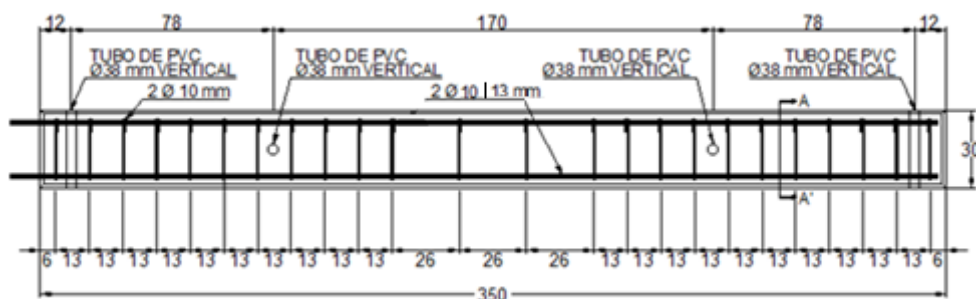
Sección longitudinal de las traves con barras de AR longitudinal a tensión de 10 y 13 mm
